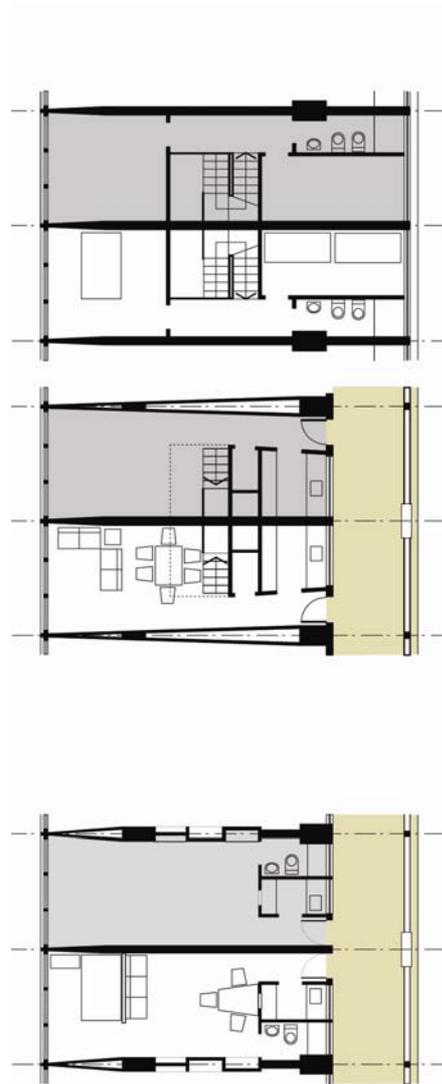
Planta Duplex de dois apartamentos de um dormitório, (Fonte: FRENCH, 2009).
